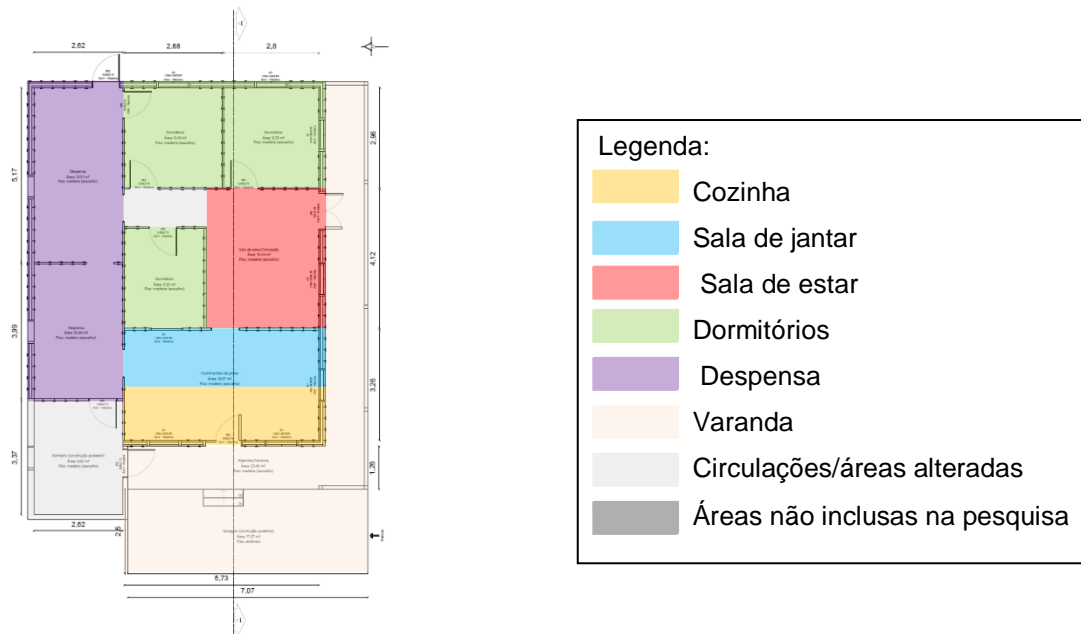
Planta baixa da Ficha 06, residência Henz.
